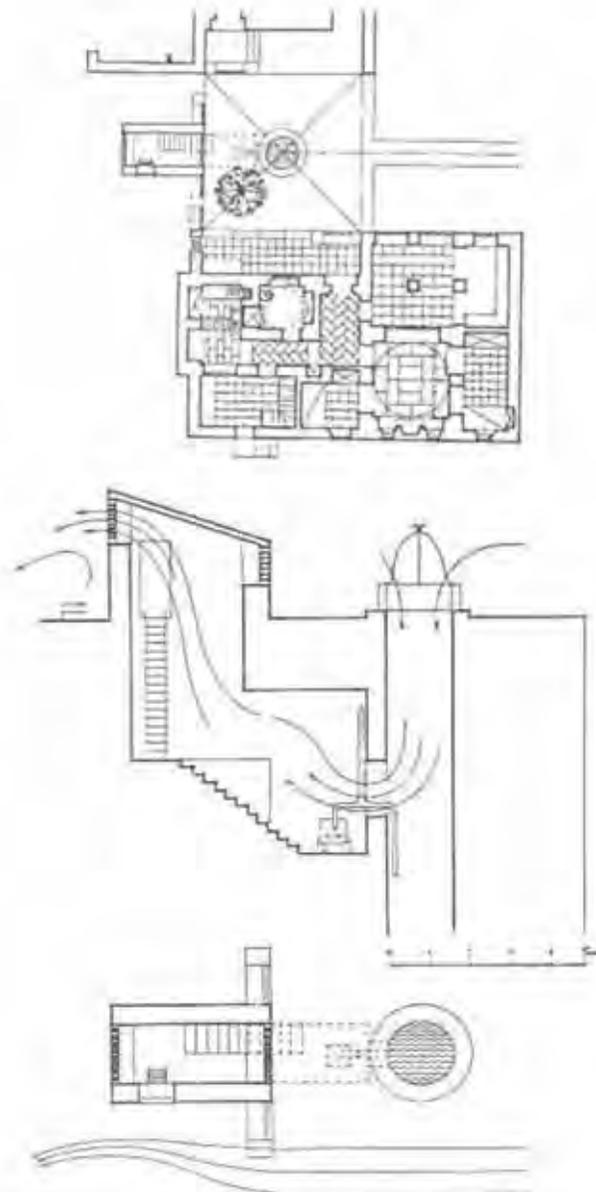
Grundriß und Schnitt durch den Pumpenraum des Hauses Sidî Krîer, der die durch den Windauslaß geschaffene Ventilation zeigt.
